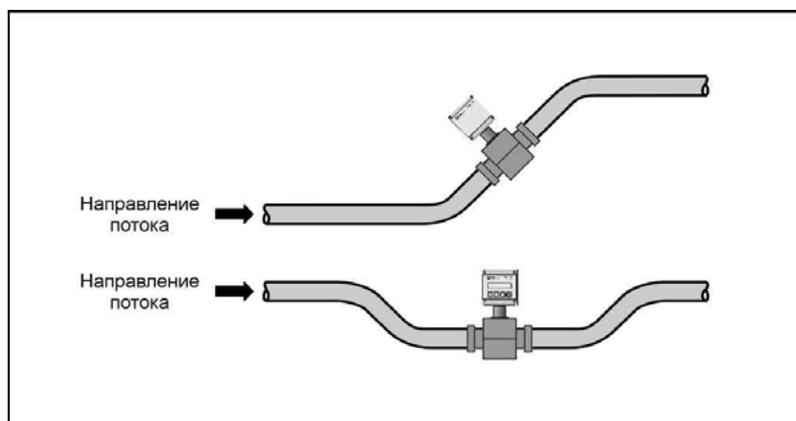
Рекомендованное размещение ПР на горизонтальном трубопроводе.
